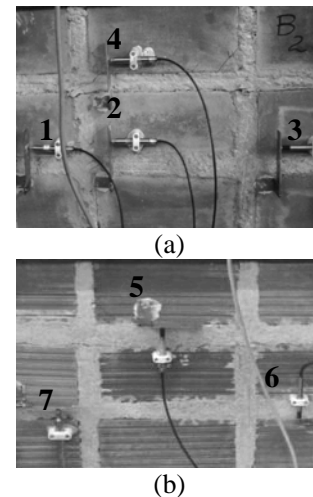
Instrumentação dos painéis ensaiados: (a) Posição dos LVDT's (1,2,3 e 4) para medição de deslocamentos horizontais, na frente dos painéis; (b) Posição dos LVDT's (5,6 e 7) para medição de deslocamentos normais, na face posterior dos painéis.
